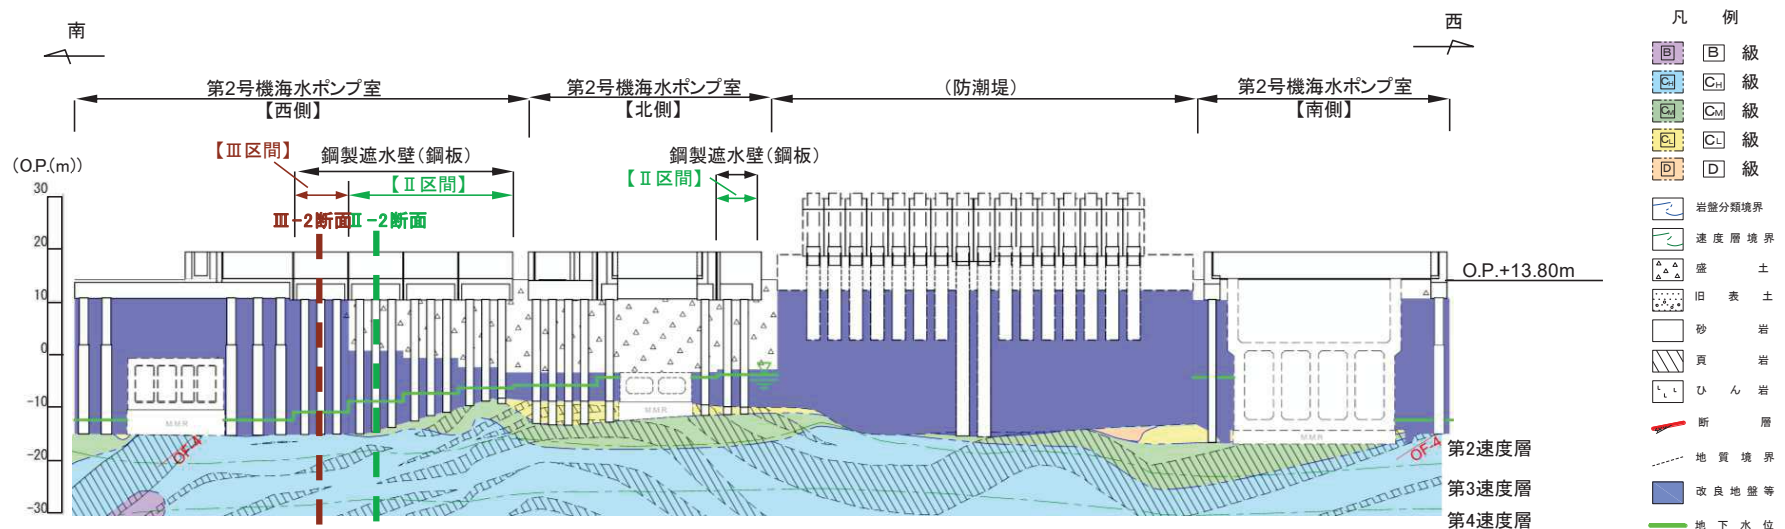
(1) 評価候補断面の地質縦断図 (第2号機海水ポンプ室)
